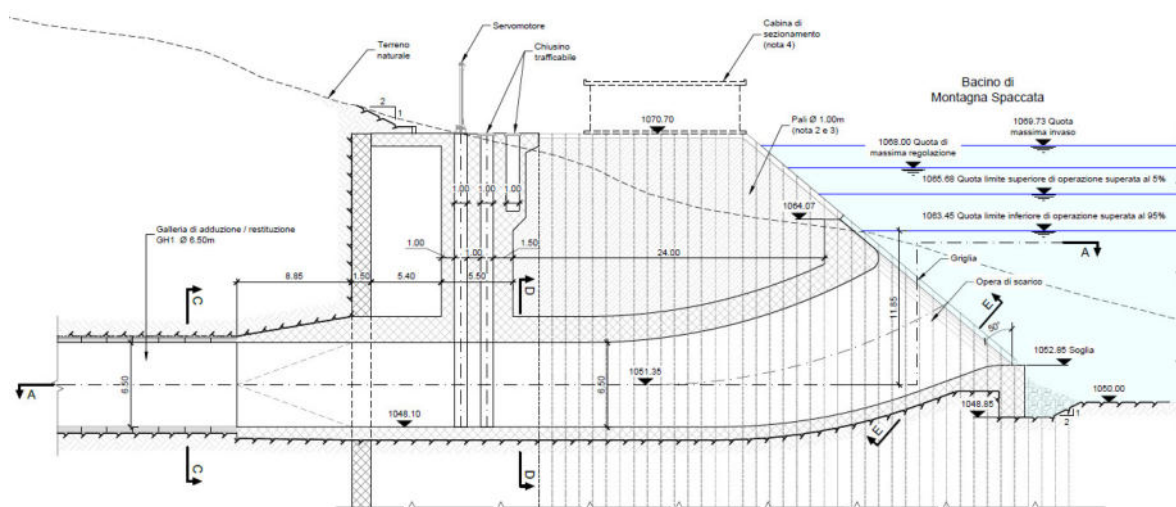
Serbatoio di Montagna Spaccata – nuova opera di presa/restituzione – sezione longitudinale.
